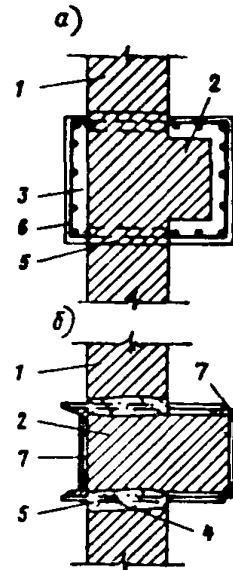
Усиление несущих стен с пилястрами железобетонными рубашками и металличе-
